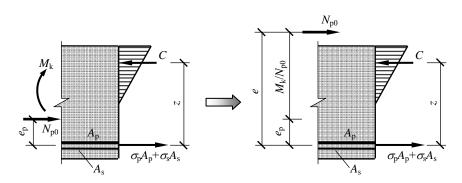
预应力钢筋和非预应力钢筋合力点至受压区合力点的距离
